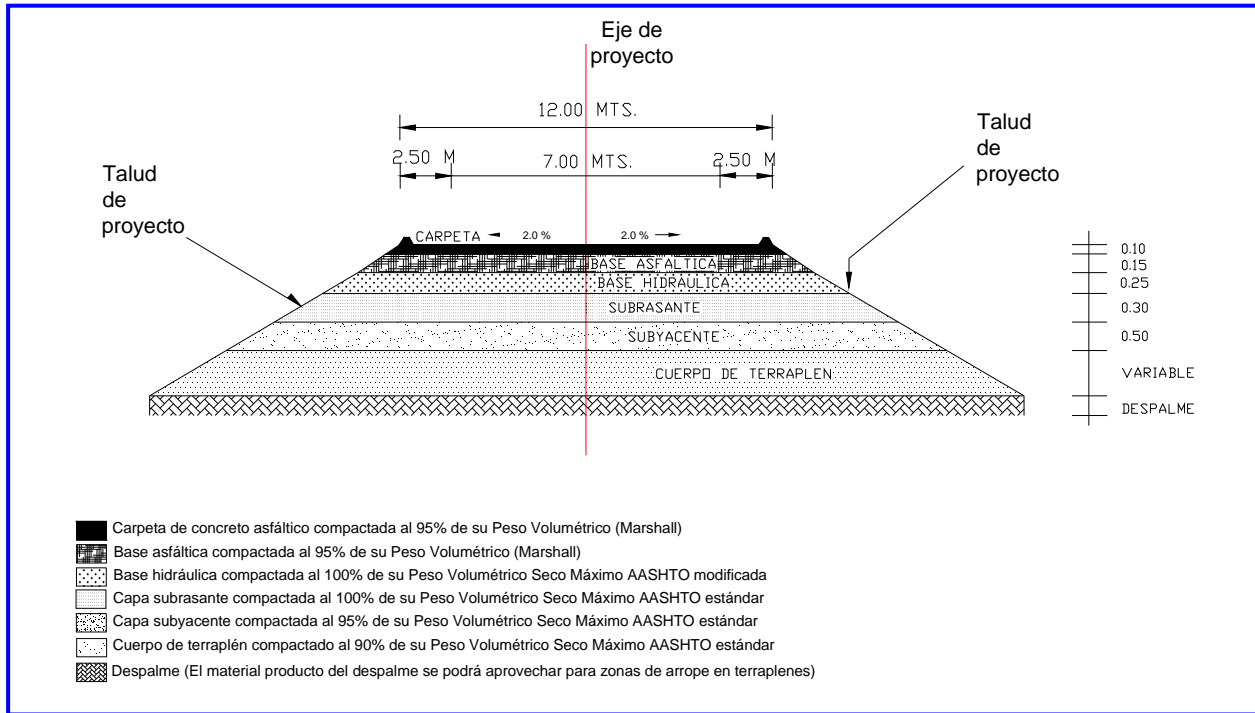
SECCIÓN ESTRUCTURAL TIPO (EN TERRAPLEN)
